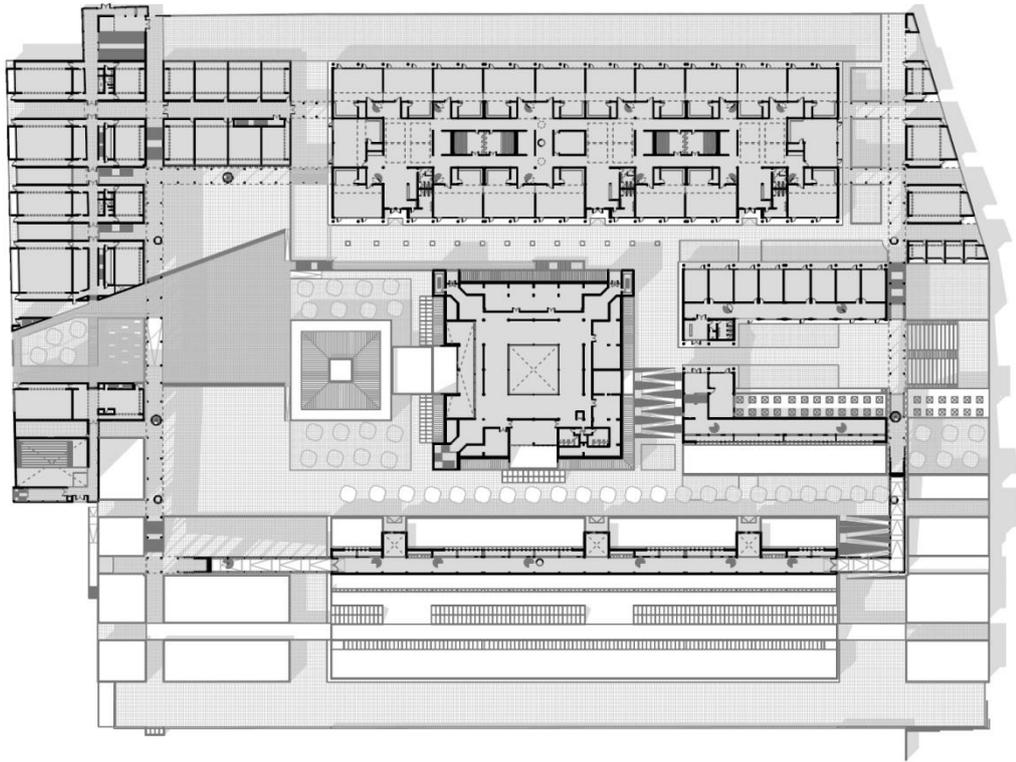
Planta do piso 1 da Faculdade de Arquitectura
